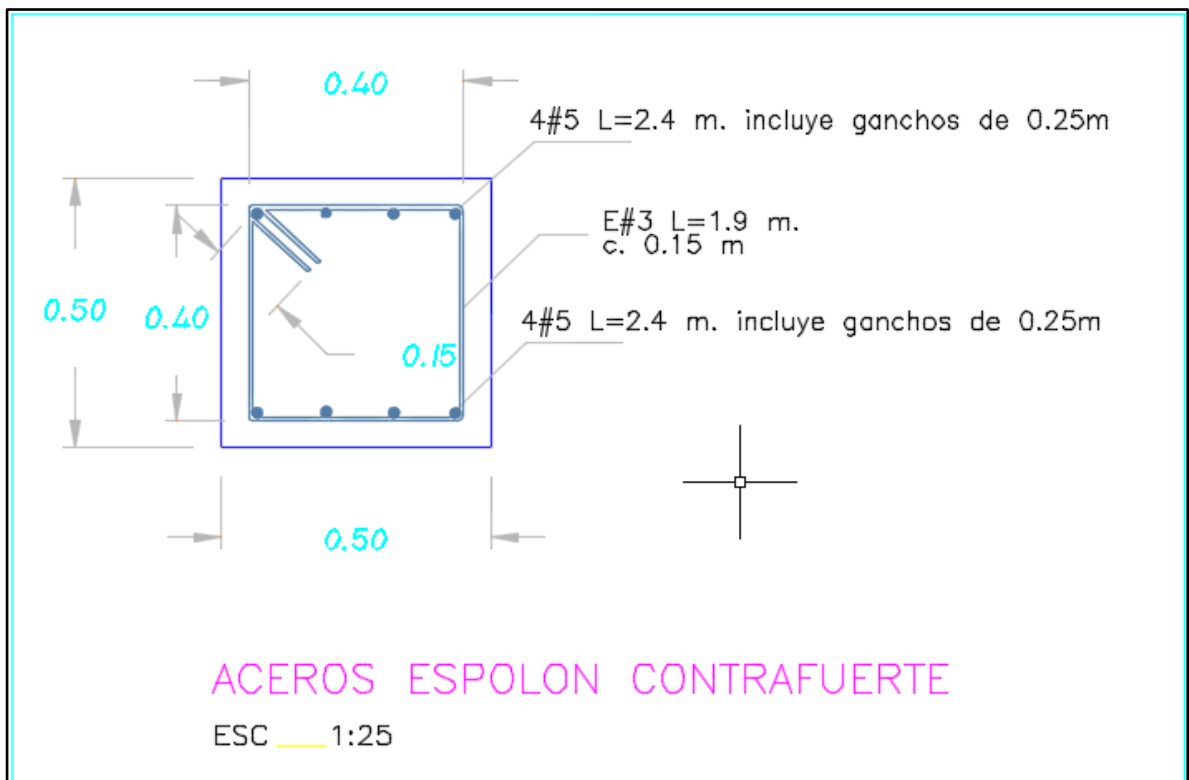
Perforaciones de contrafuerte muros de contención del Box coulver k34+190
